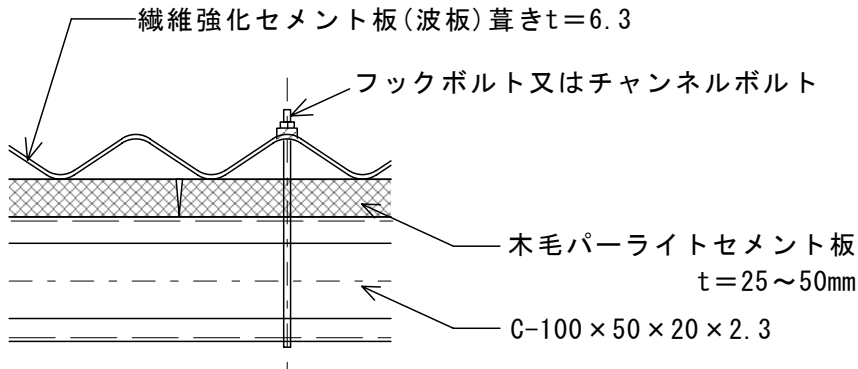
水平断面図 (繊維強化セメント板下地 : 波板葺き)
